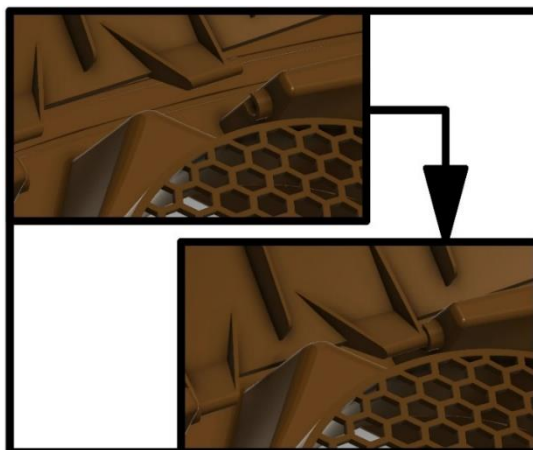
Установка колпака аэратора MONTERREY.
